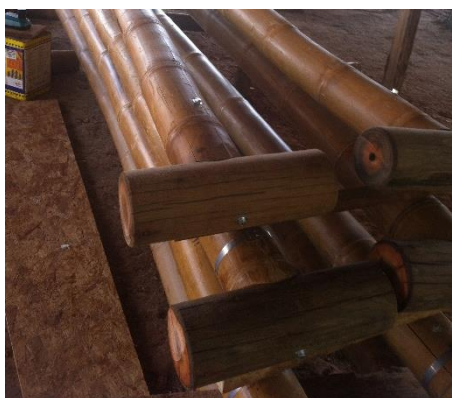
Detalhe de peças de eucalipto torneado para padronização das uniões
